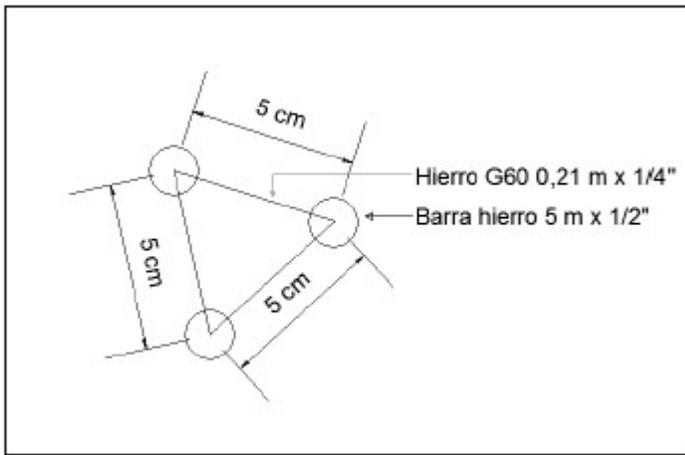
Varilla de refuerzo 5 m (Vista en planta).
